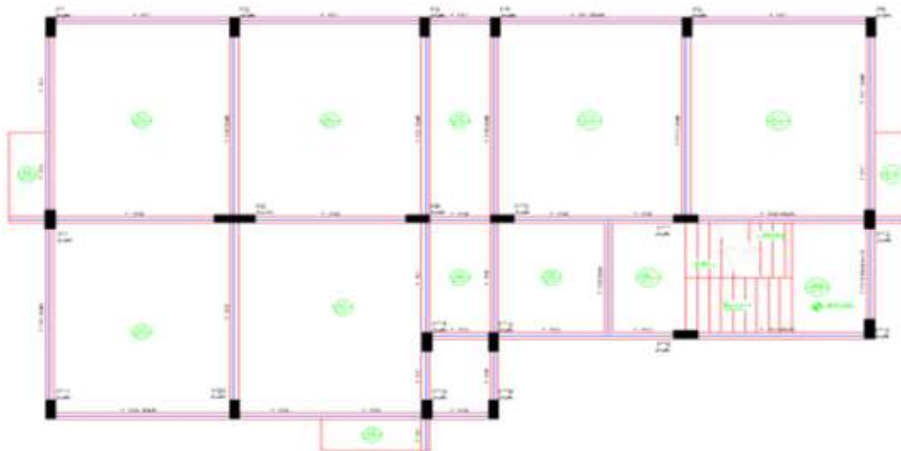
Planta de fôrmas - pavimento tipo. Fonte: O autor, 2014.
